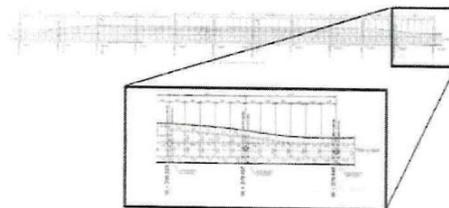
Vista del plano de la sección del tramo elevado que colapsó (entre las estaciones 10+272 y 10+242).
